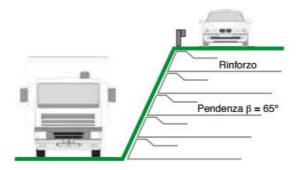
Sezione tipo rilevato in terra rinforzata
